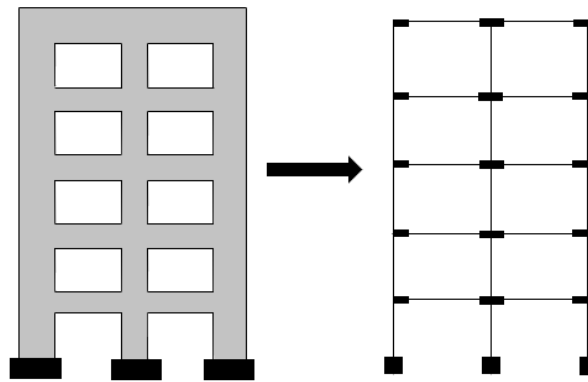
Melhoria aplicada a pórticos planos: trechos rígidos.
